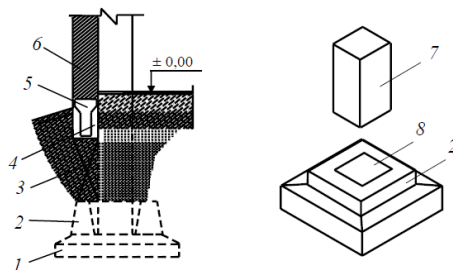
Столбчатый фундамент: 1 – основание; 2 – башмак; 3 – бетонный столбик под балку; 4 – балка; 5 – гидроизоляция; 6 – стена; 7 – колонна; 8 – стакан для колоны
